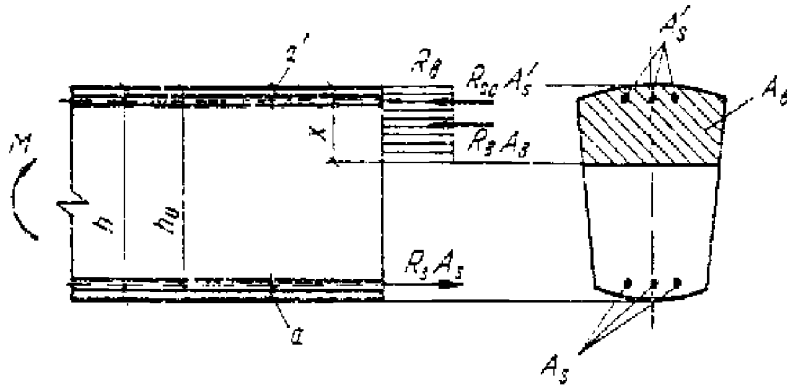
Схема усилий и эпюра напряжений в сечении, нормальном к продольной оси изгибаемого железобетонного элемента, при расчете его по прочности
